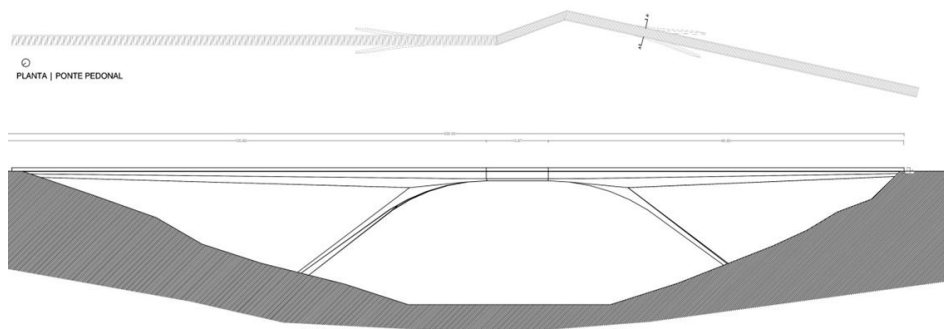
Planta (em cima) e alçado vista sul (em baixo) da proposta para a ponte pedonal
